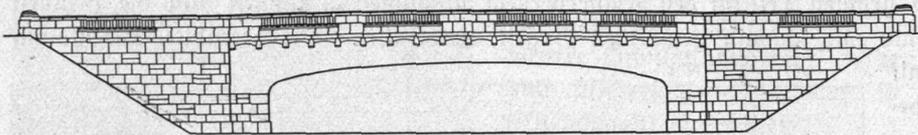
und 310. Barmbecker Straßenbrücke, Ansicht und Brüstungsgrundriß.
